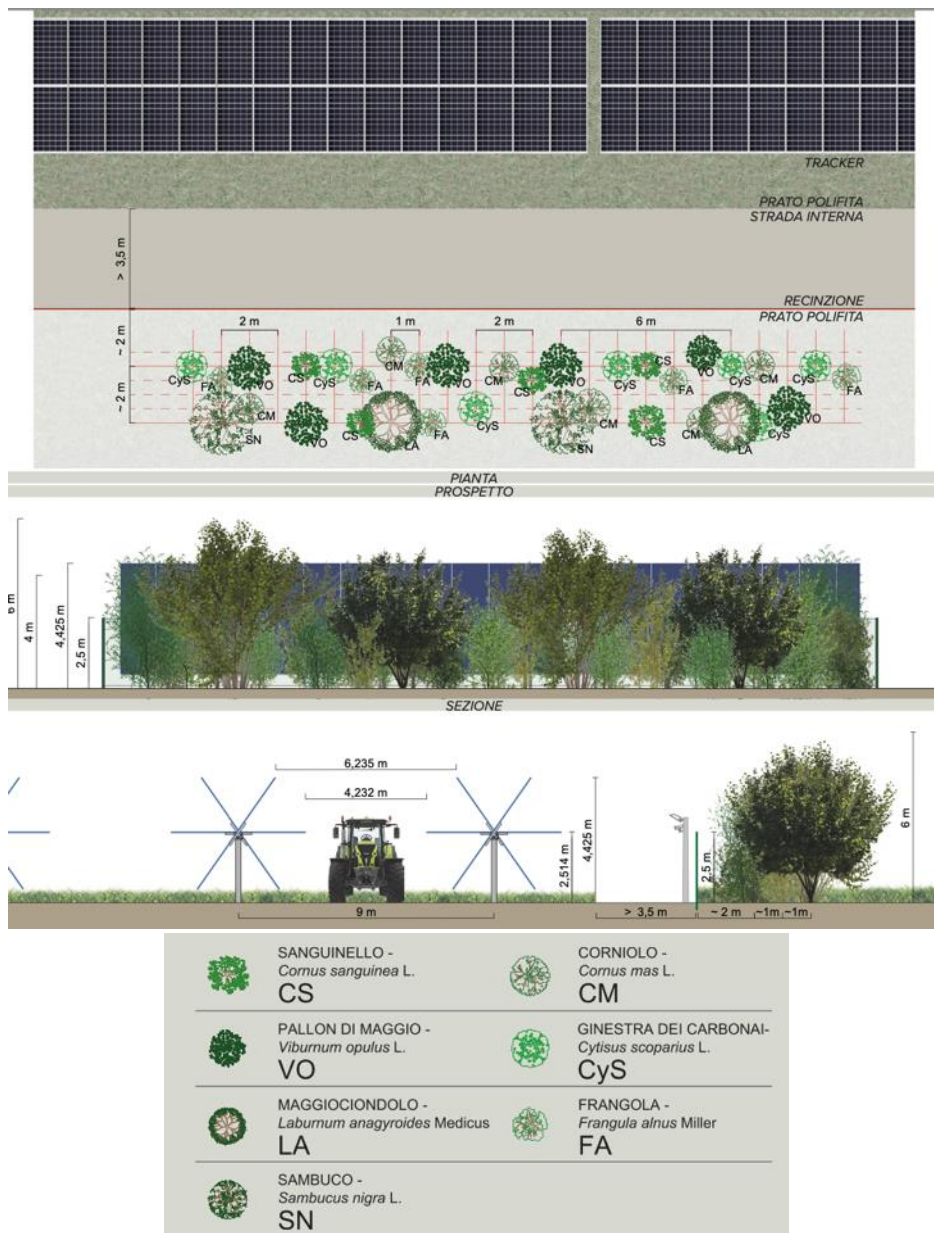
Sesto di impianto, prospetto e sezione delle fasce vegetate di Tipo 2
